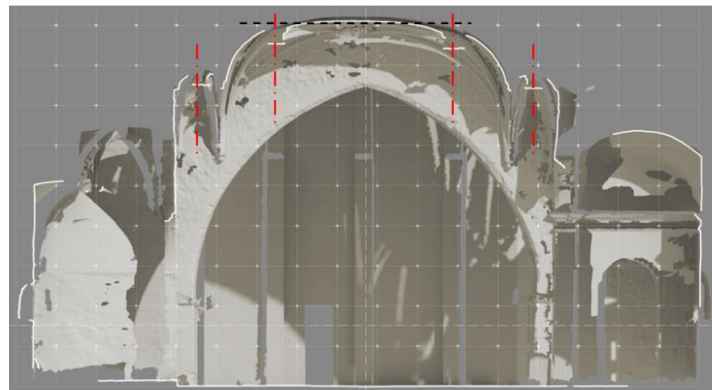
En esta imagen se puede observar los ejes verticales de las claves y la zona de la bóveda casi plana.
